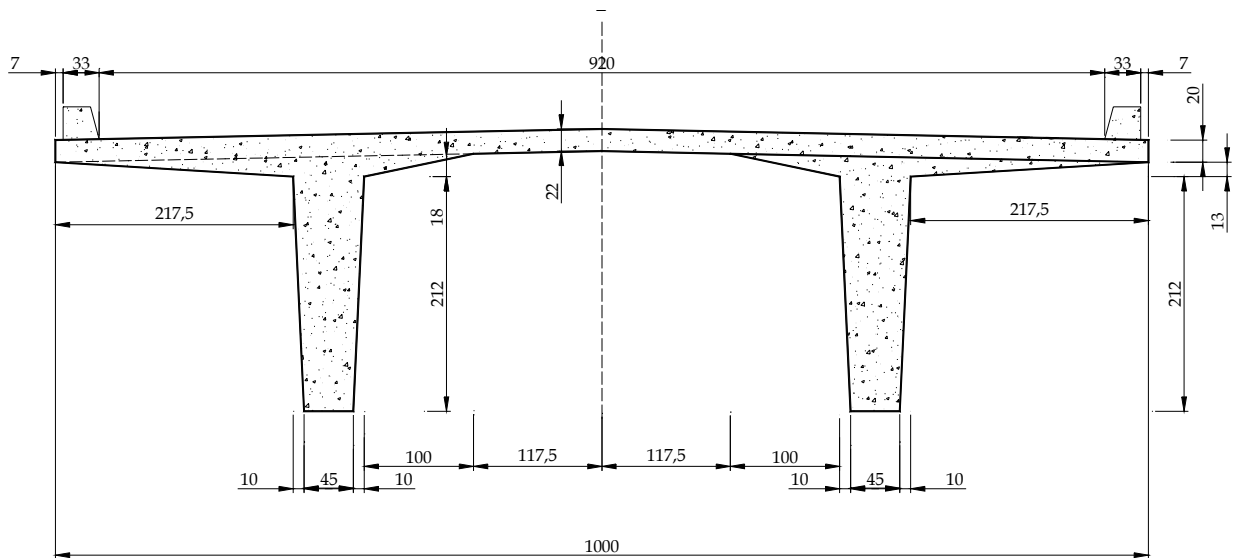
Sección transversal de la superestructura con nervaduras. Proyecto tipo, longitud del claro 28 m
